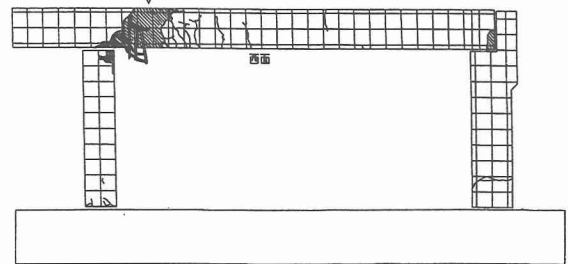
ひび割れ状況(I-3, H=3.5m)
